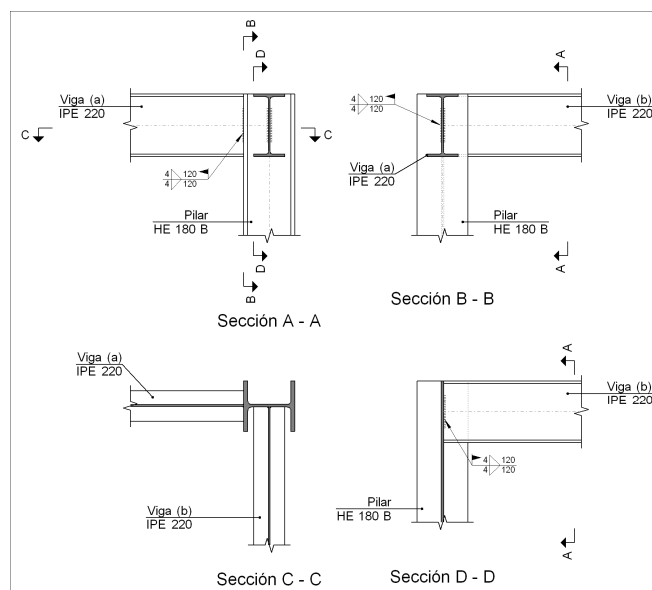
Detalle de las soldaduras tipo 3 del soporte superior
